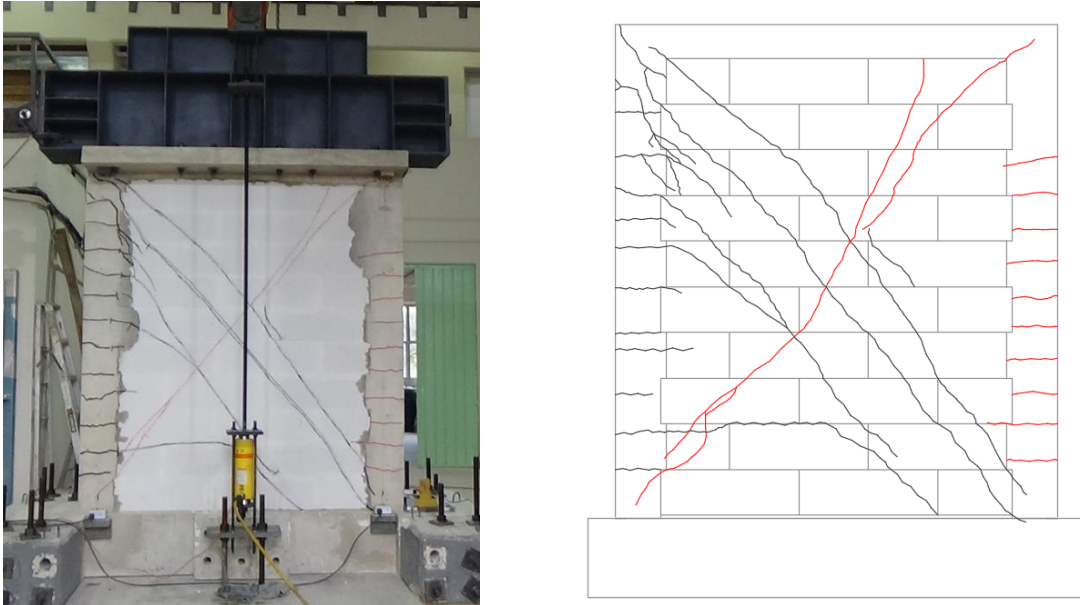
Grietas diagonales al alcanzar la carga maxima del muro M-1.23-4.8
